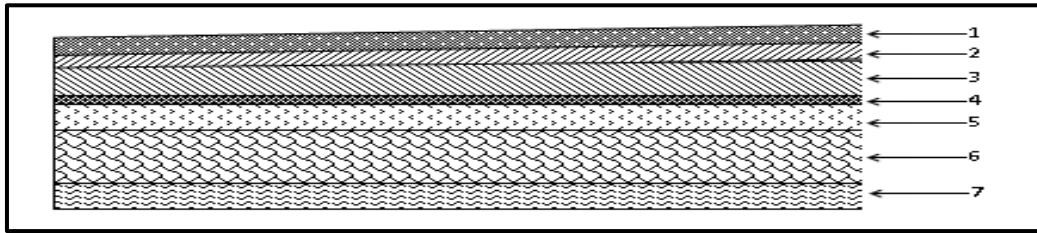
Coupe transversale du plancher terrasse inaccessible
